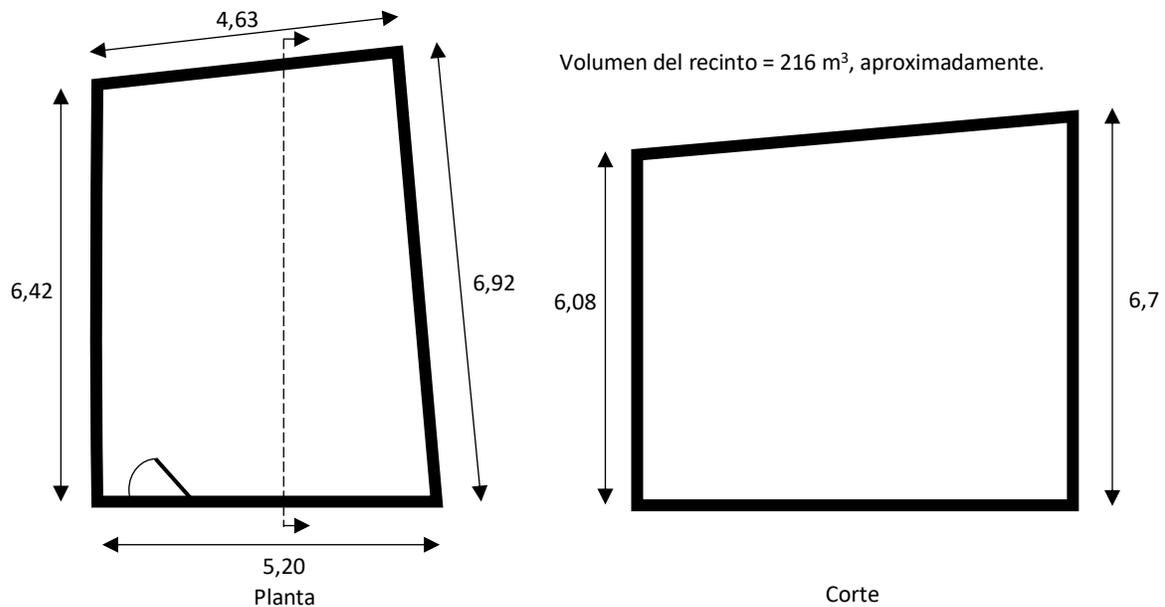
Esquema de planta y corte de los recintos de ensayo
